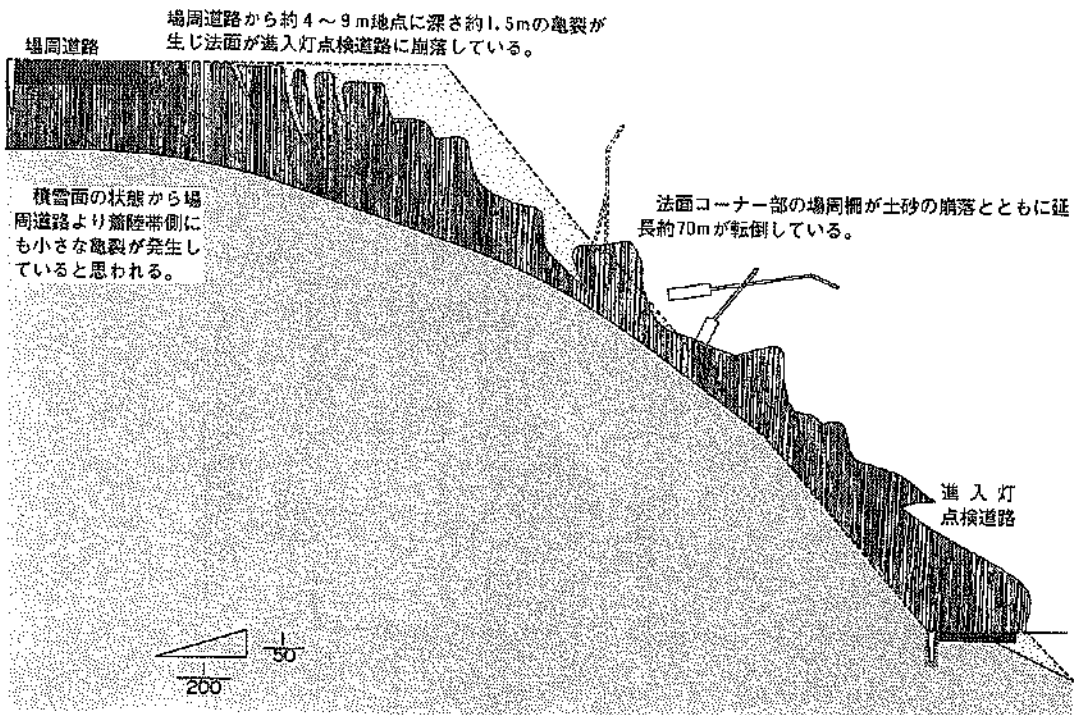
釧路空港南西側の盛土被災状況断面図 (C-C断面)
